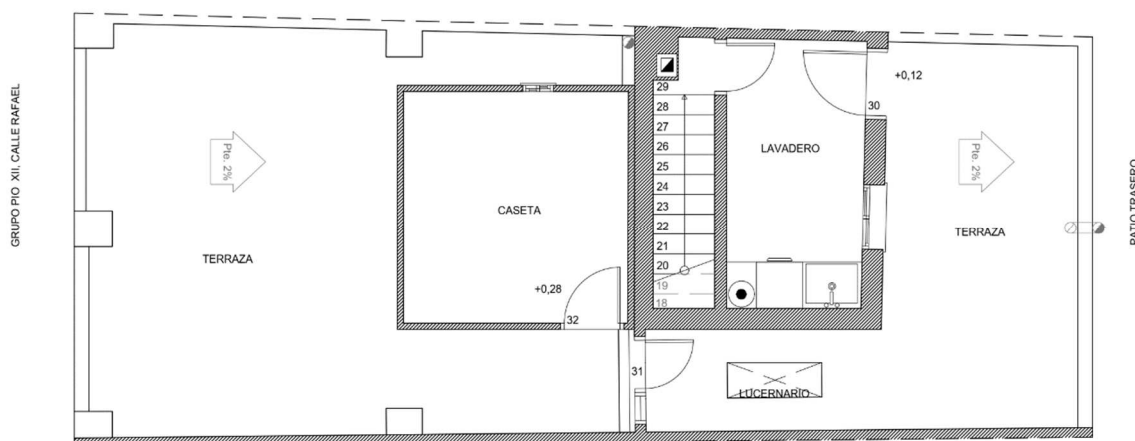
Planta cubierta AutoCAD. Fuente propia programa AutoCAD
